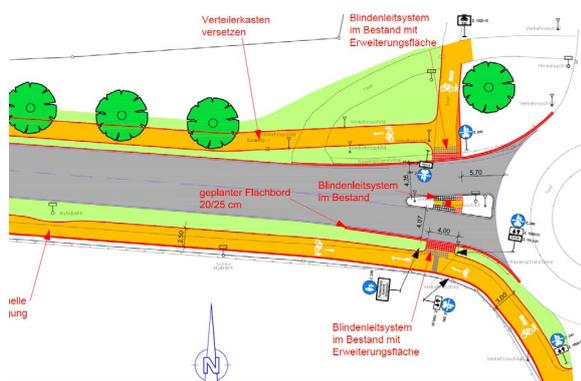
Ausschnitt Radwegführung Kapellenstraße; *Quelle: Stadt Limburg
